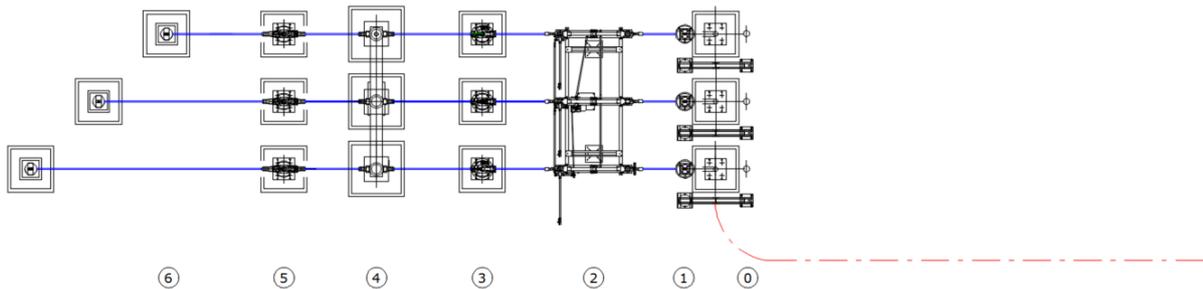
Planimetria elettromeccanica Stallo Partenza linea in cavo AT 132 kV da condividere
